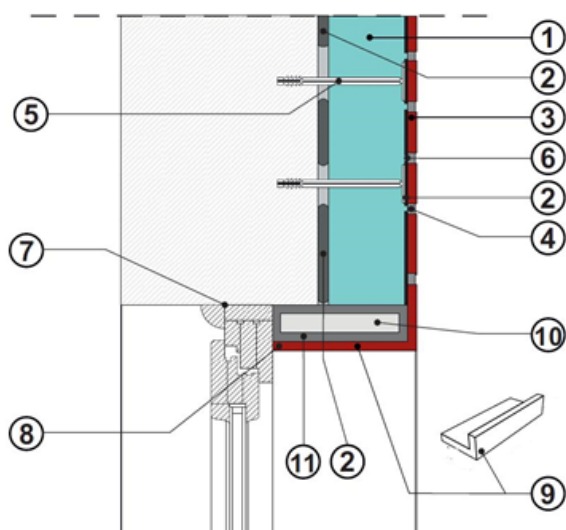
Esquema de aplicação nas esquinas das placas de isolante do sistema CANDIWALL
